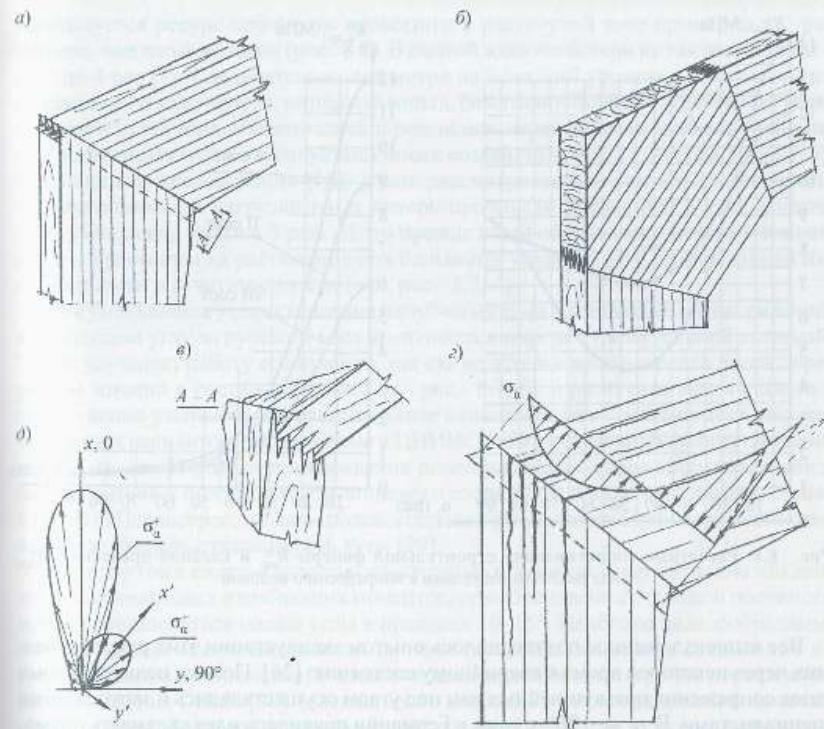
Цельноклеёные карнизные узлы с соединением на зубчатый шип под углом: а – при непосредственнойстыковке блоков; б – с переходной прямоугольной вставкой; в – ослабление в виде «бабочки»; г – эпюра σ_η в биссектрисном сечении и схема трещин в узле; д – схема совмещения напряжений и сопротивлений древесины в опасных точках узла (отсутствие следящей ориентации)
